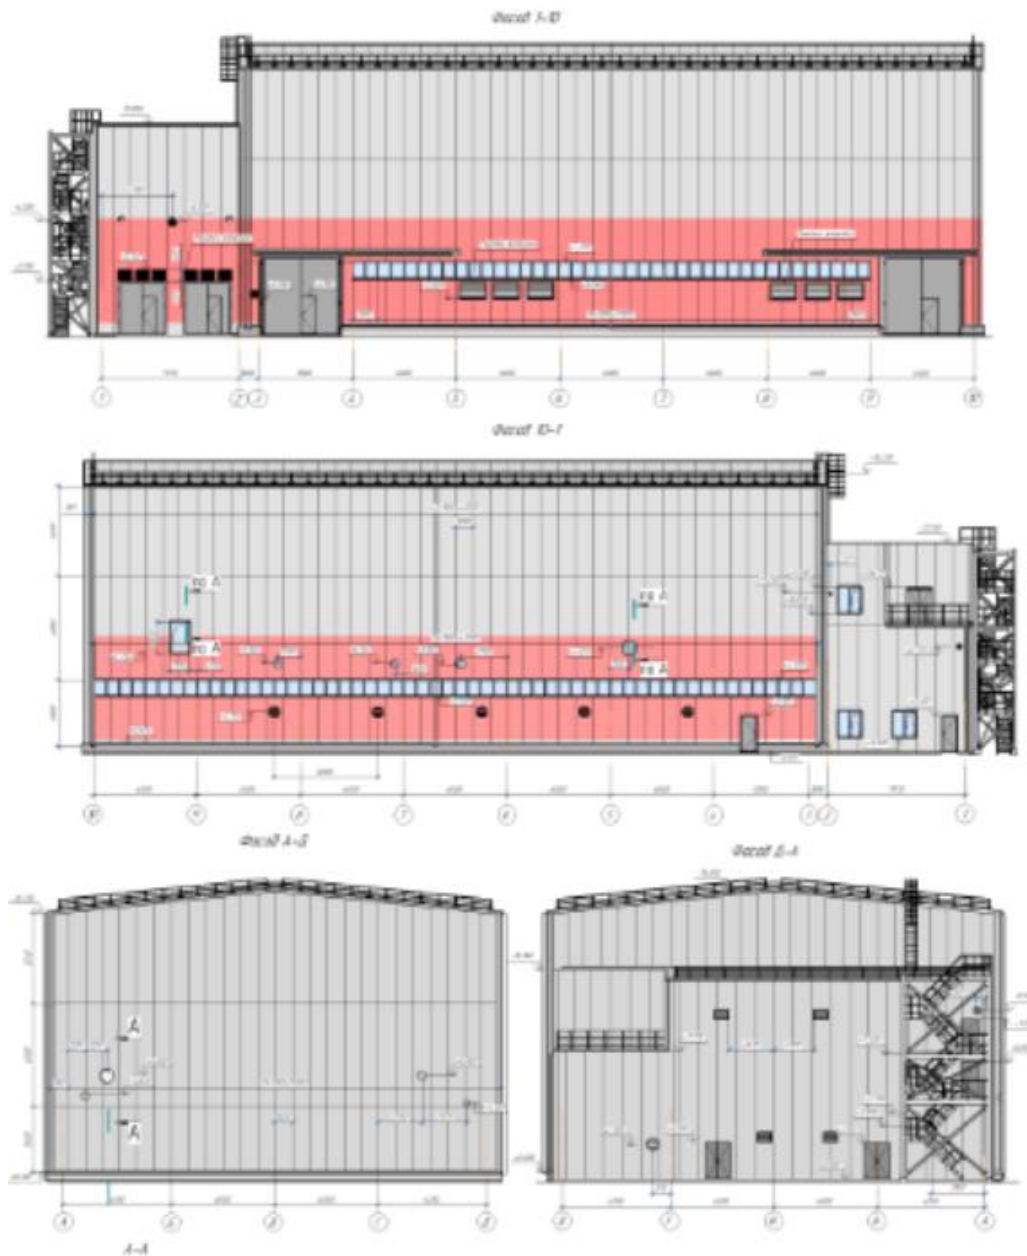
Фасади будівлі вакуум-насосної станції.
